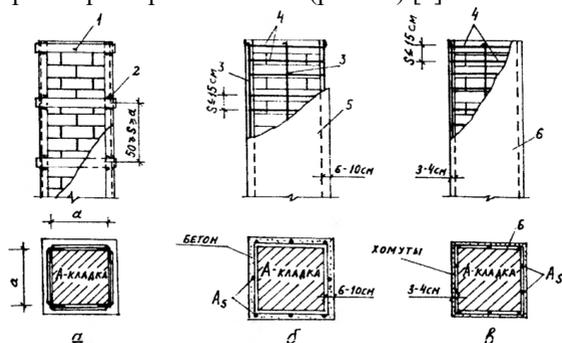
Схема усиления кирпичных столбов обоймами: а – металлической; б – железобетонной; в – армированной штукатуркой; 1 – планка сечением 35х5...60х12 мм; 2 – сварка; 3 – стержни; 4 – хомуты; 5 – бетон; 6 – штукатурка
